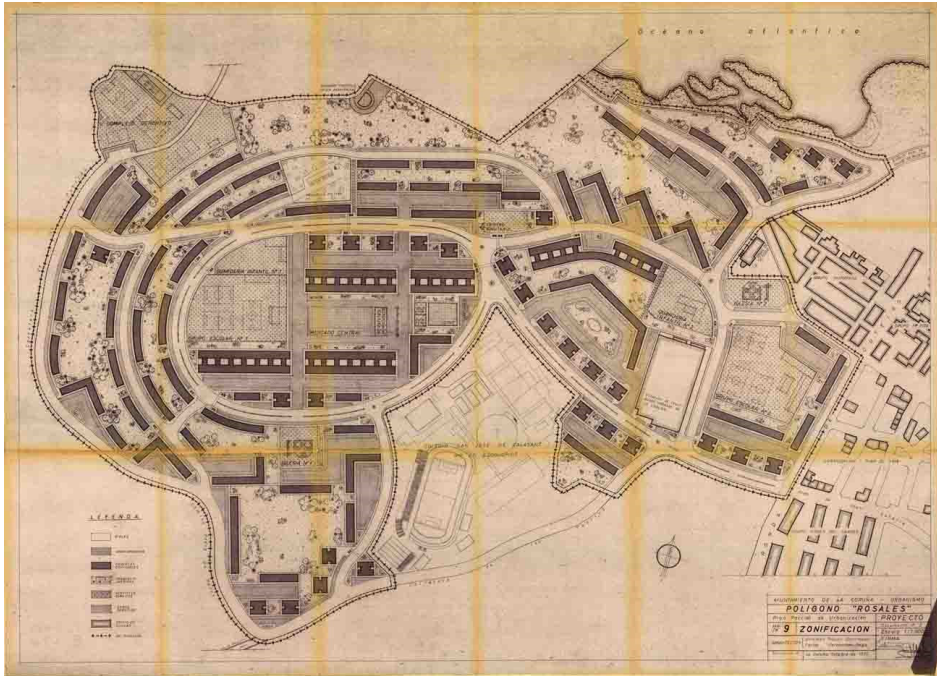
Plano General Plan Parcial de Rosales Norte. Fuente: Archivo General de Fomento.
